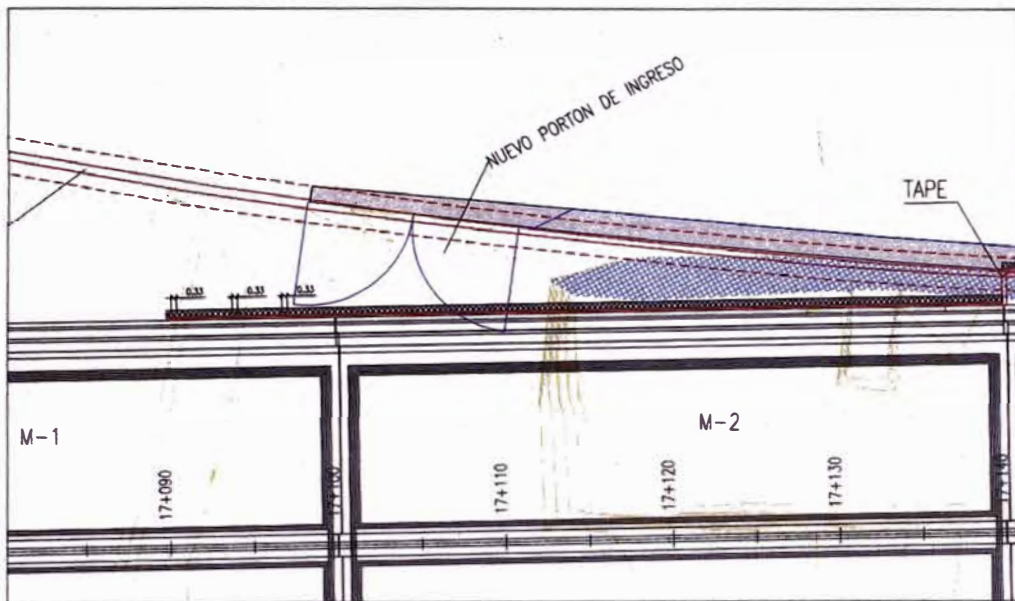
vista en planta del muro entre las progresivas 17+090 al 17+140.
